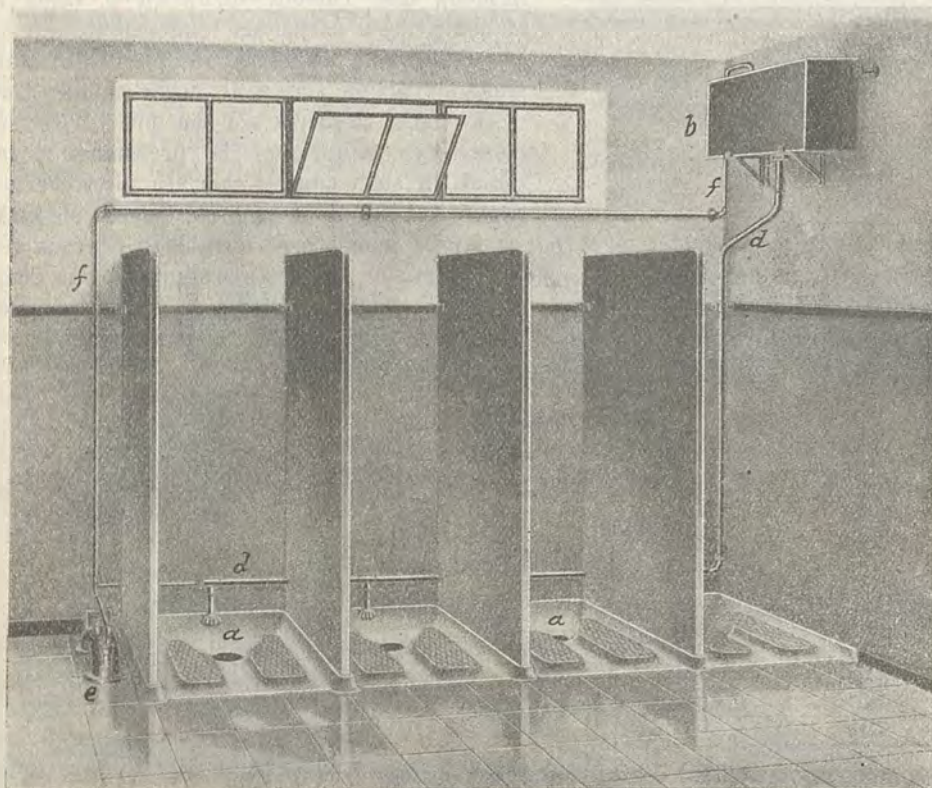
Batteria di cessi con vasi a pavimento.
